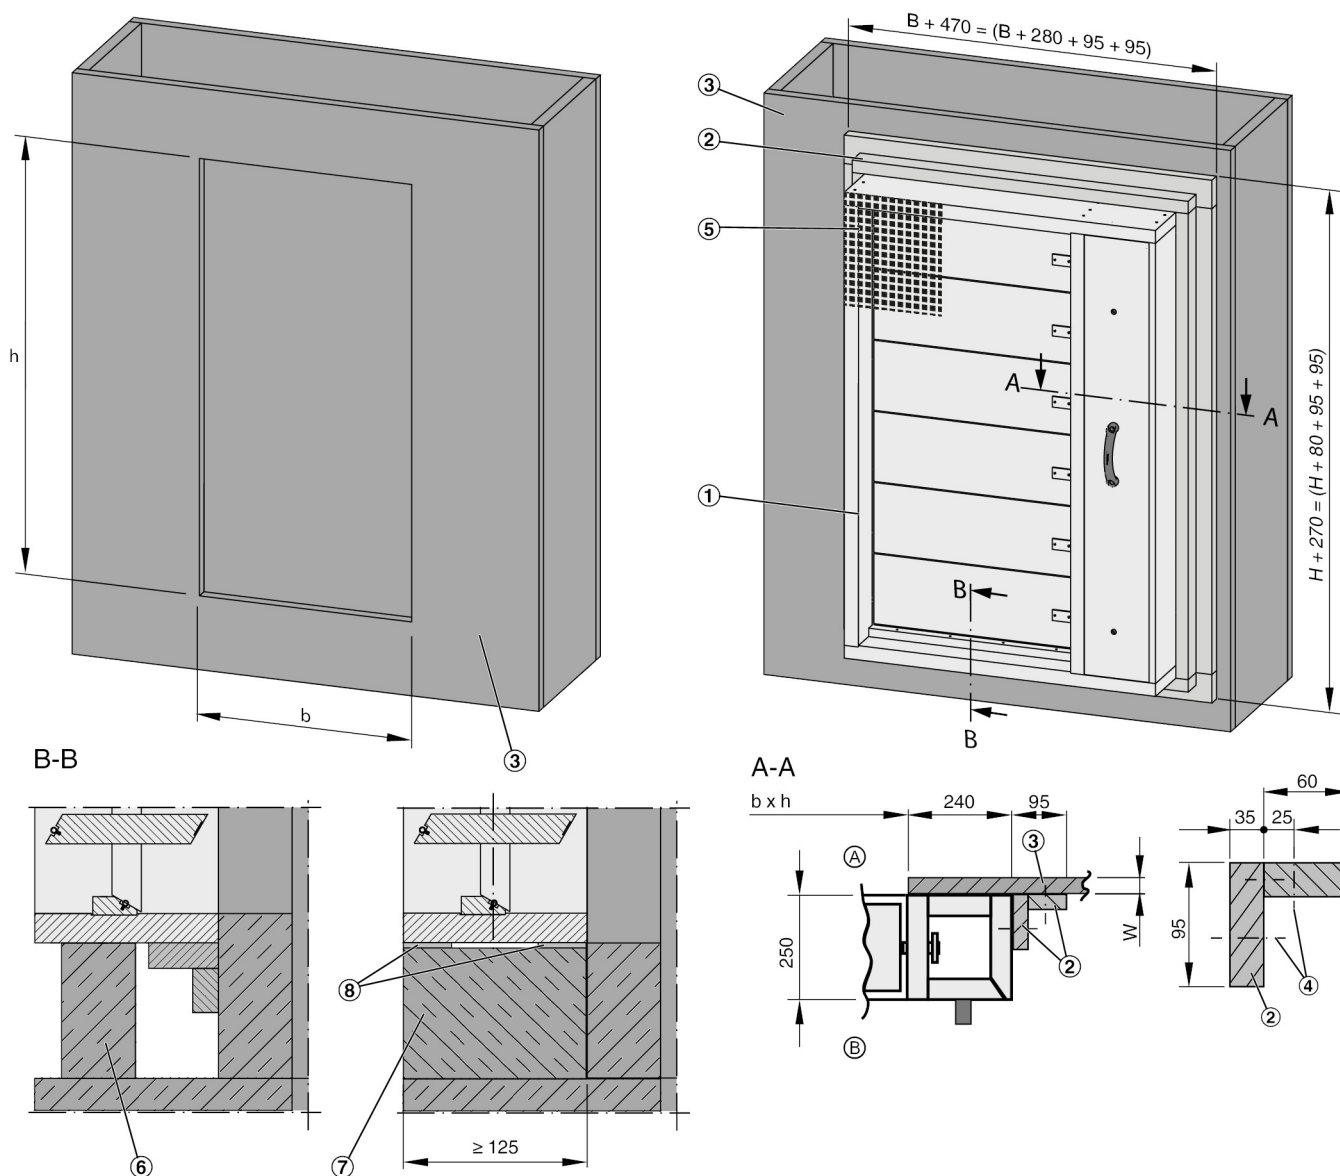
Einbau an vertikaler Entrauchungsleitung (Schacht)
